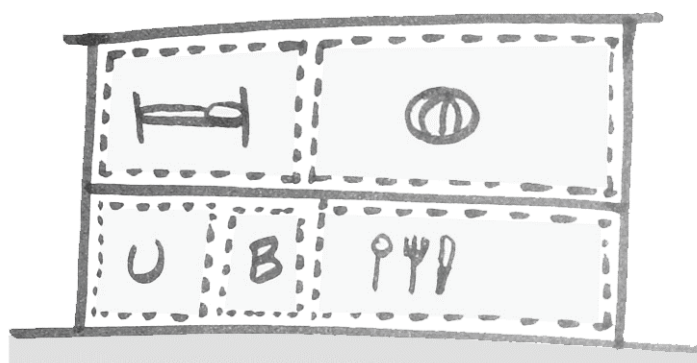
Divisione schematica delle destinazioni d'uso all'interno del blocco D. Al piano primo la zona notte e il salone, sotto l'ufficio con la biblioteca e la zona ristoro.
